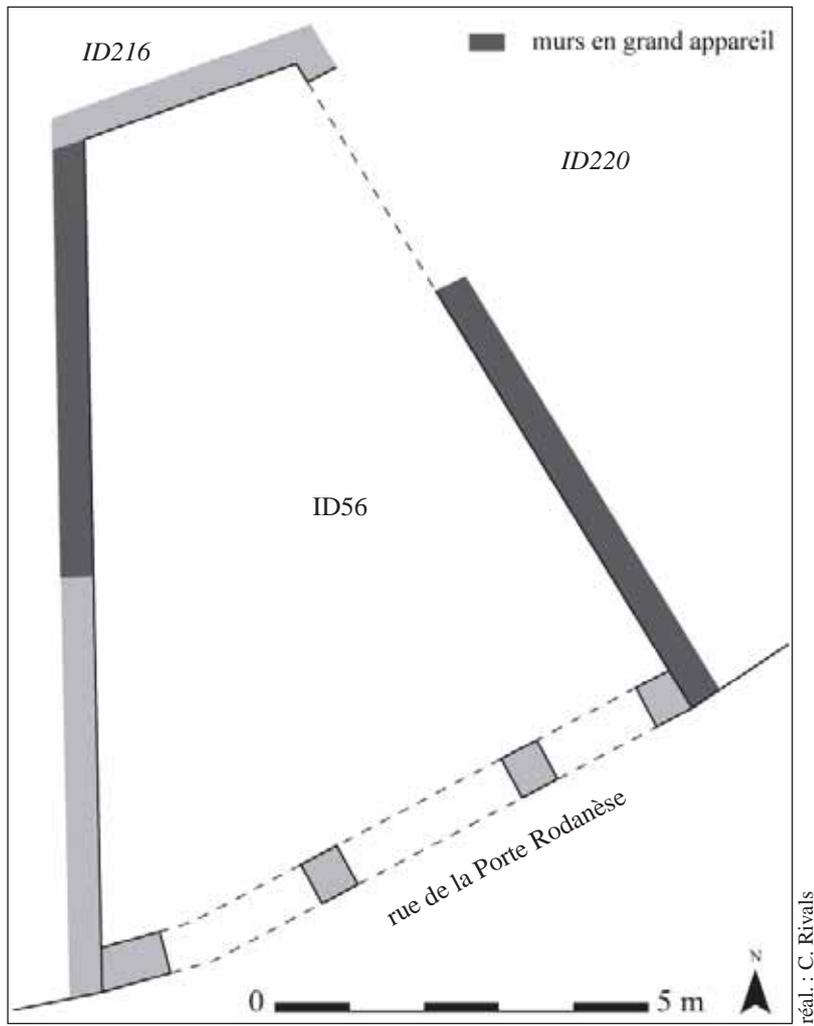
croquis à l'échelle du rez-de-chaussée
